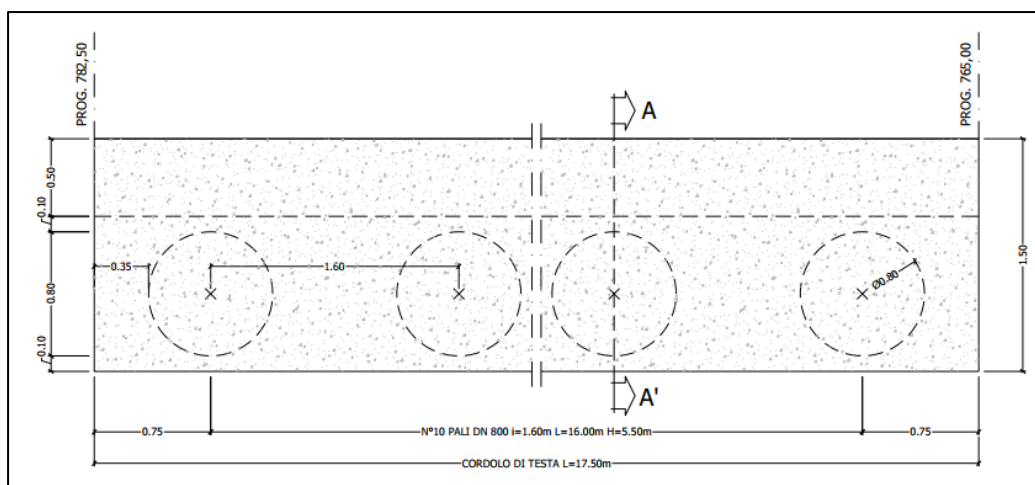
Muro di sostegno su pali MP1 – Planimetria
